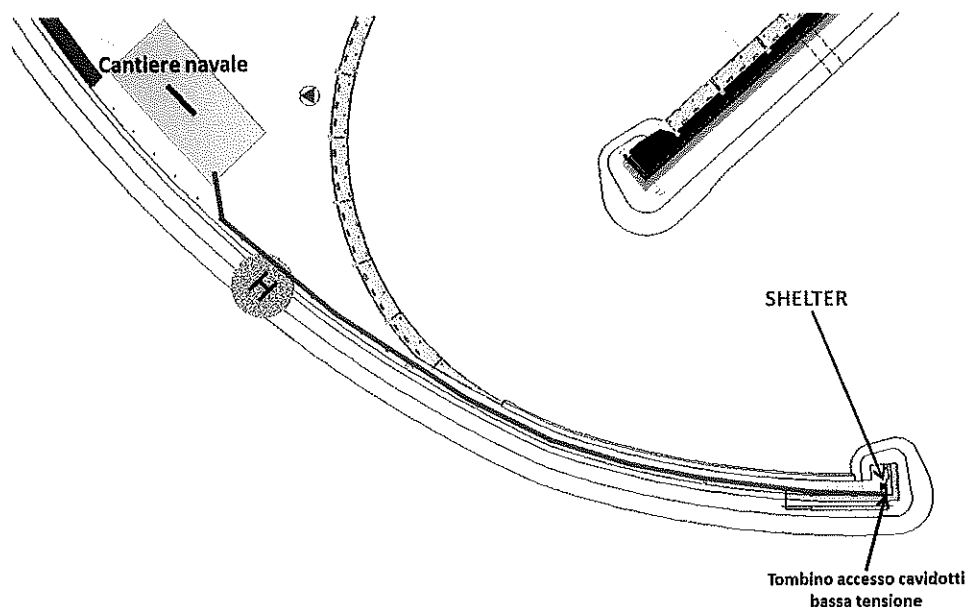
Dettaglio possibile collegamento elettrico alla linea bassa tensione del porto utilizzando prevalentemente i cavidotti della bassa tensione esistenti.
